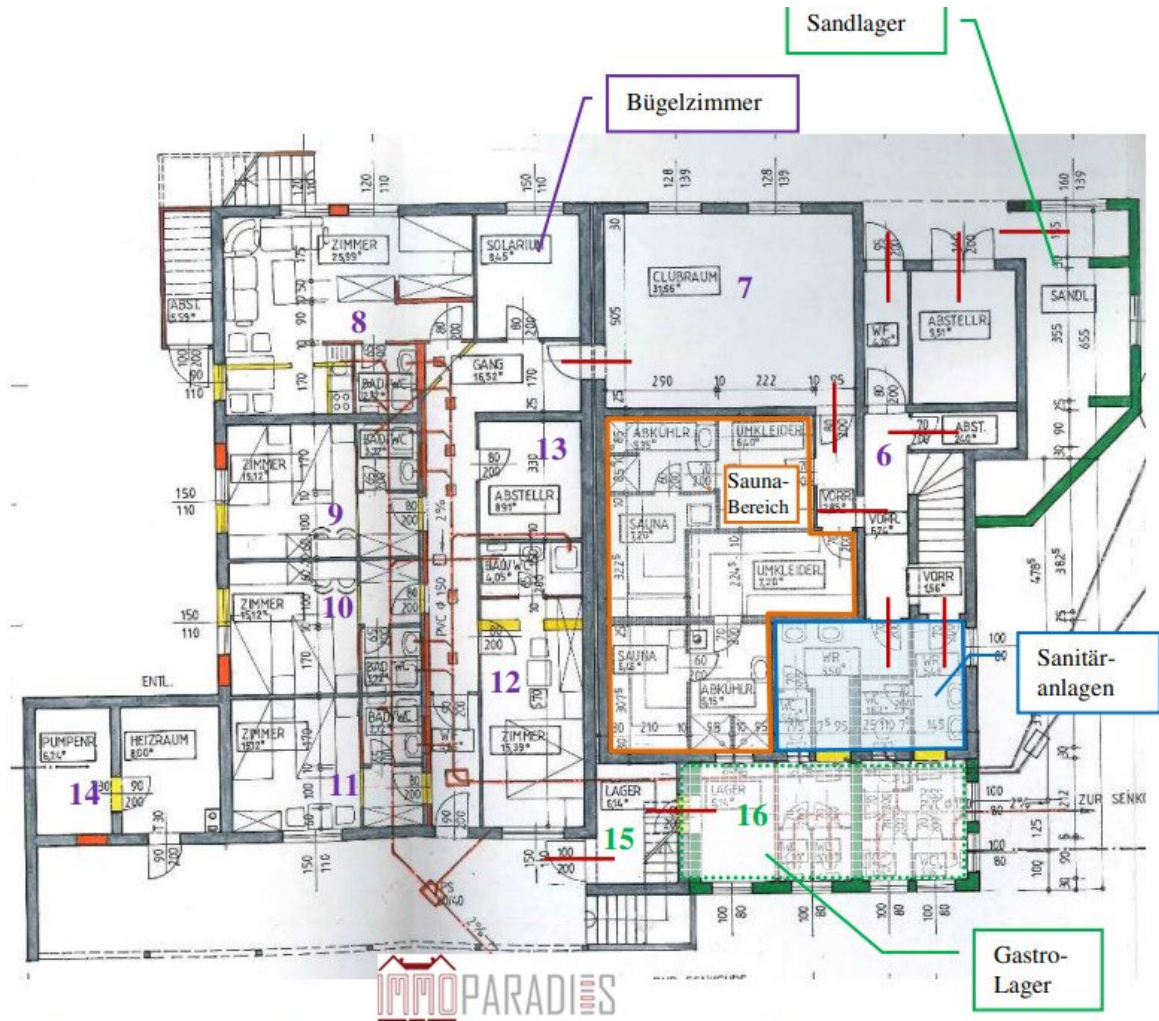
Grundriss Erdgeschoß ; Quelle: Gesamteinreichplan (22.02.1992)
